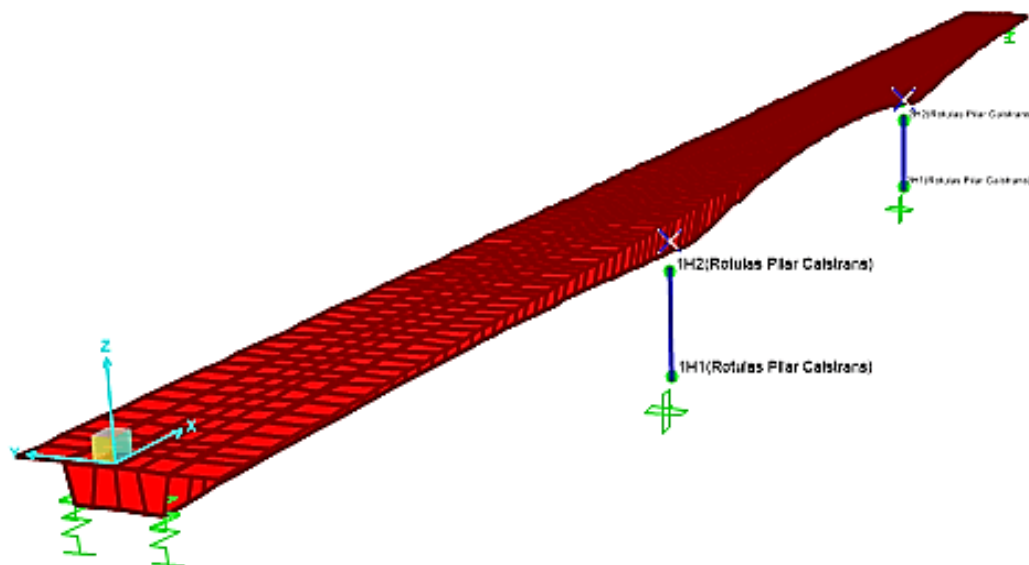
Asignación de rotulas plásticas en los pilares del puente
